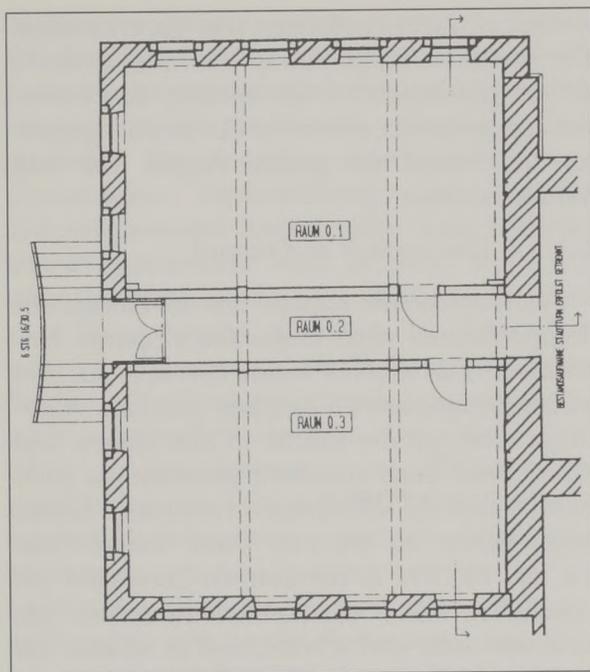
Backnang. Turmschulhaus. Grundriß. Erdgeschoß.
